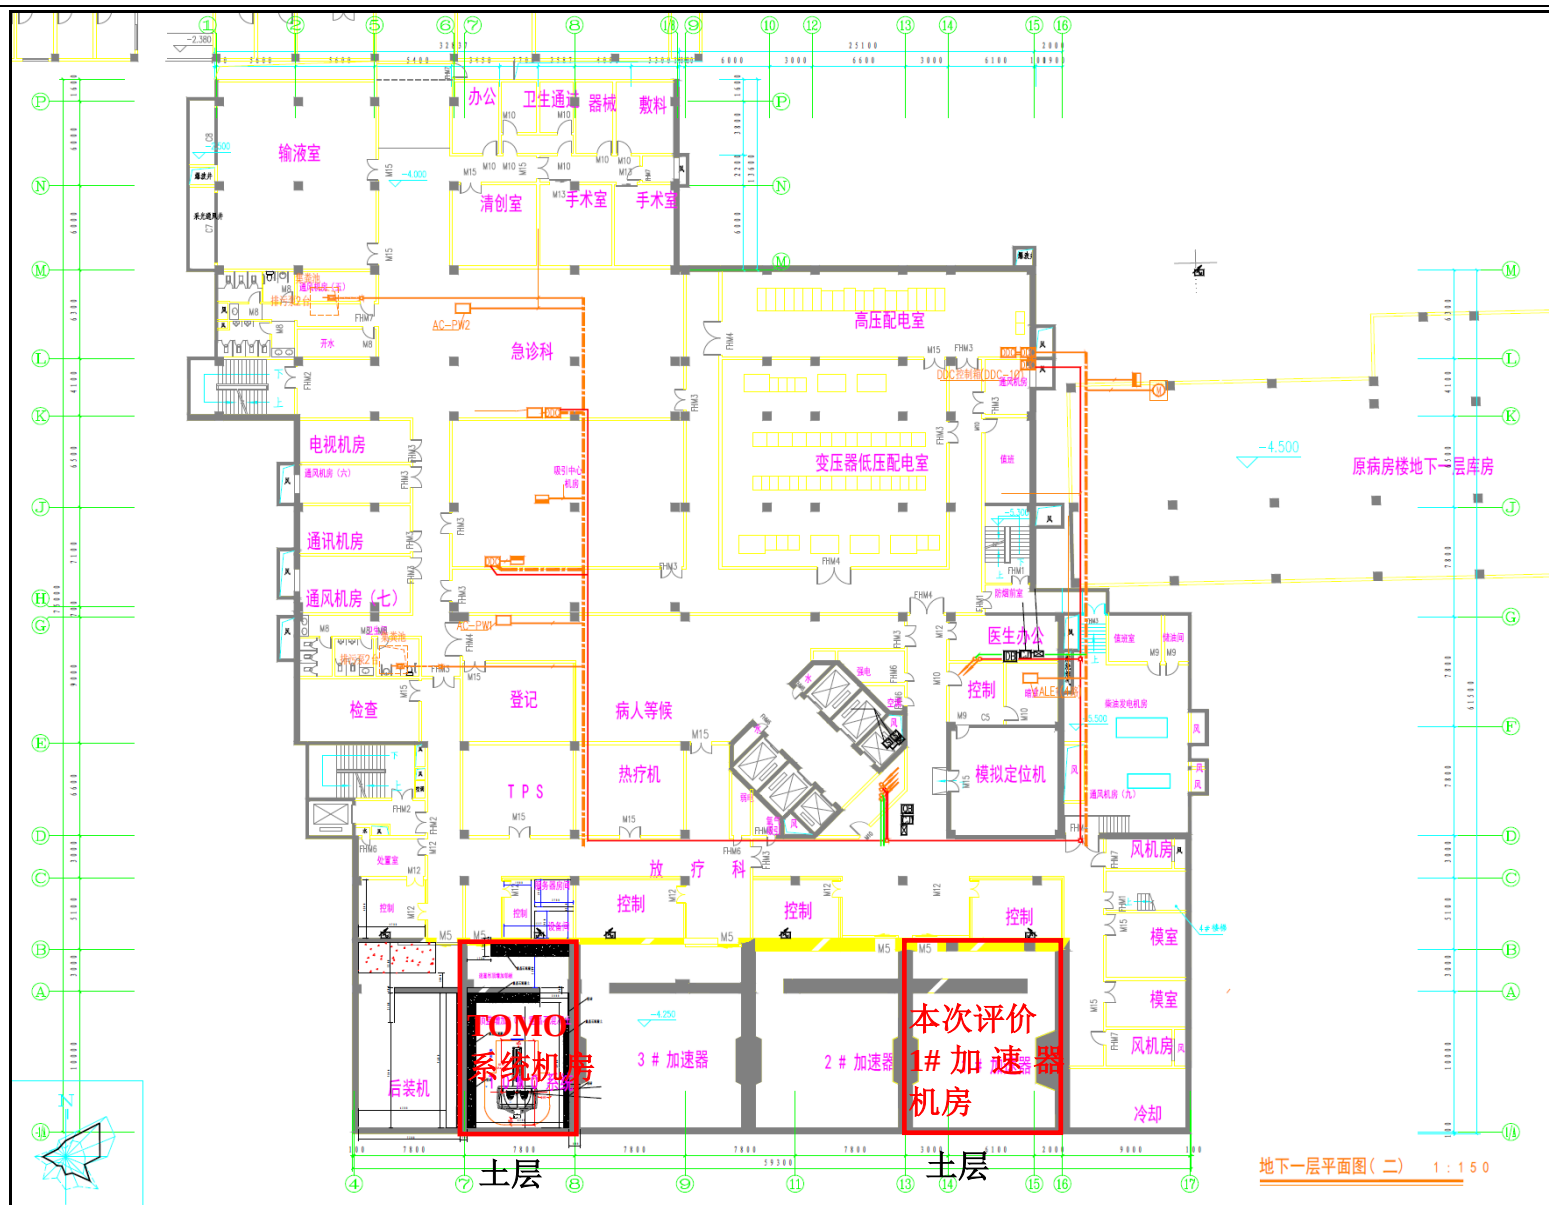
一号病房楼放疗科平面布置图（位于负一层）
